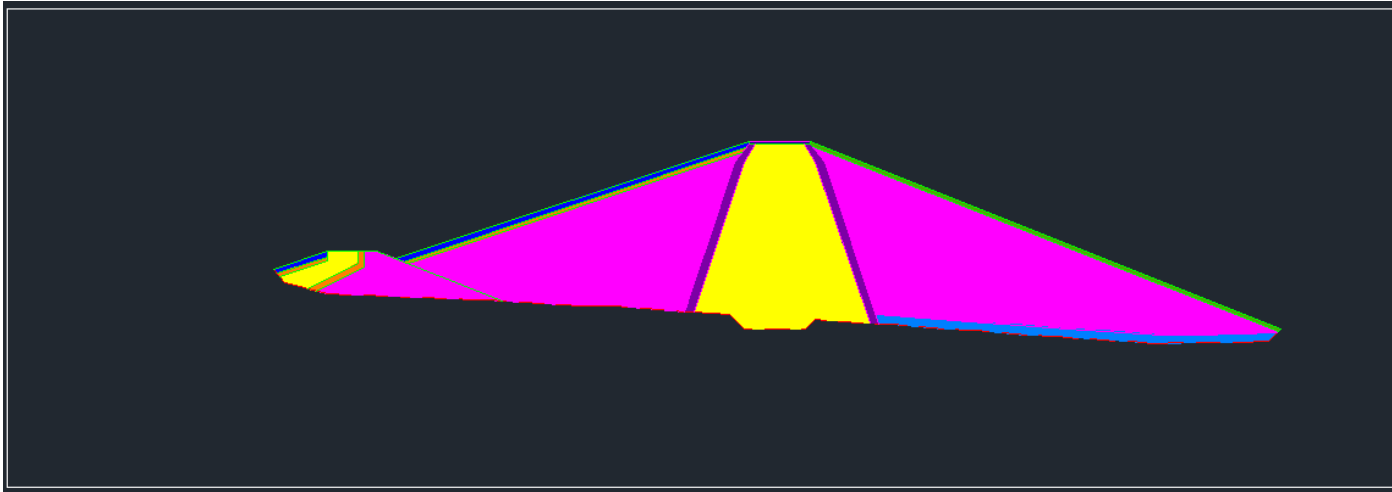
Metraj alan hesaplama – Kesit 1
